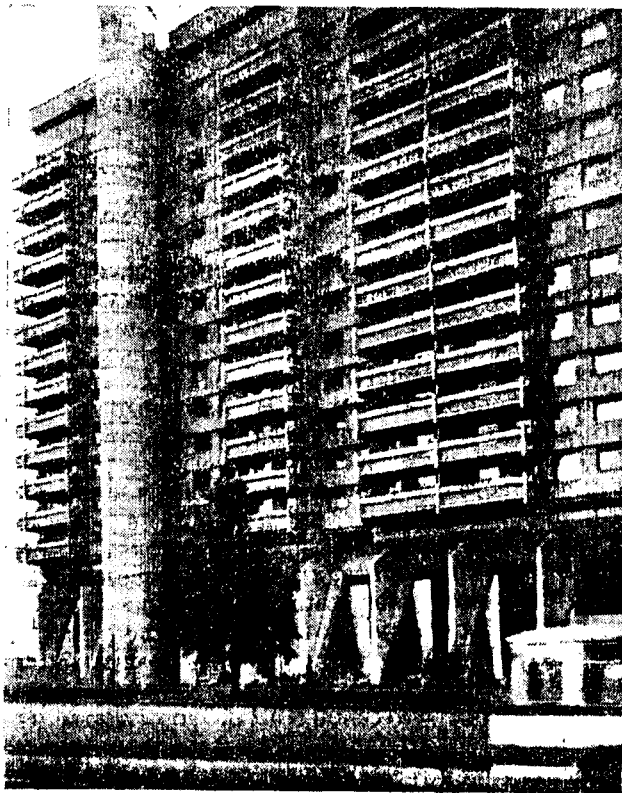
Москва. Фрагмент фасада жилого дома с различной отделкой несущих элементов и несущих наружных стен
